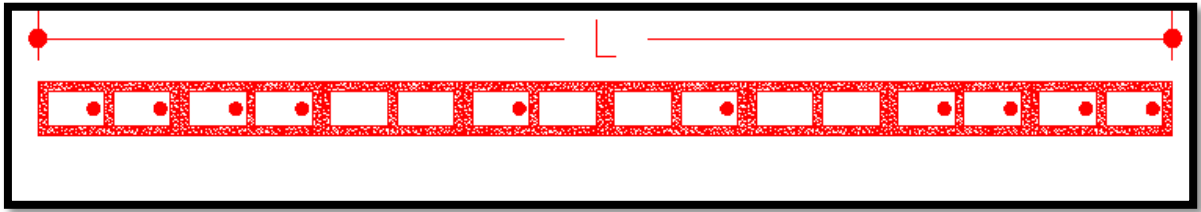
Vista de planta de Pared diseñada con refuerzo vertical.
